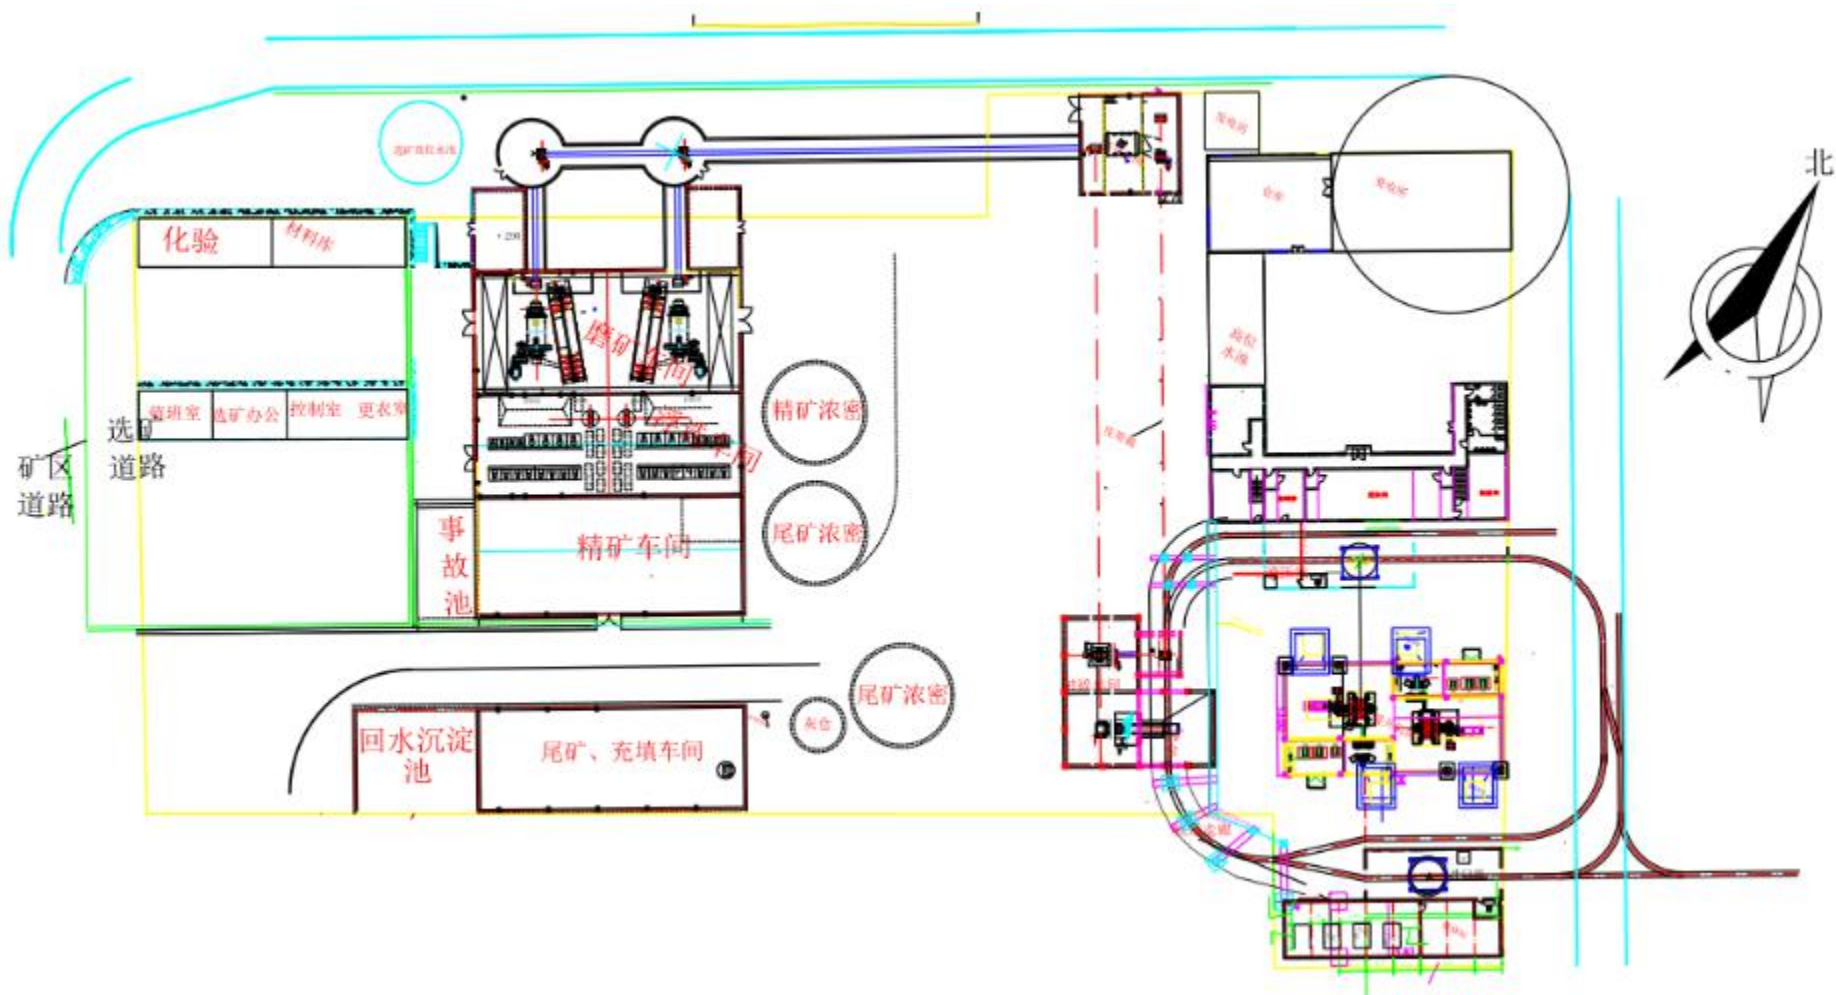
西陡崖金矿采矿区及选矿区平面布置图
